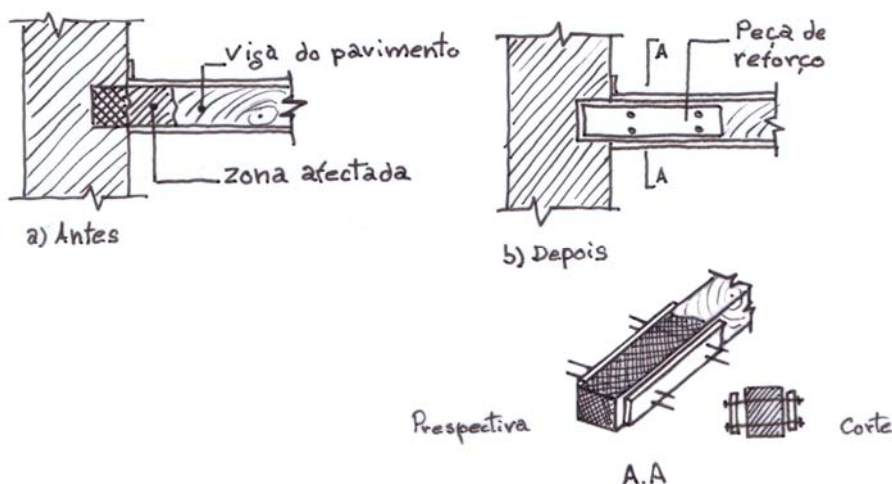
| Viga com empalme lateral (adaptado de [2])
